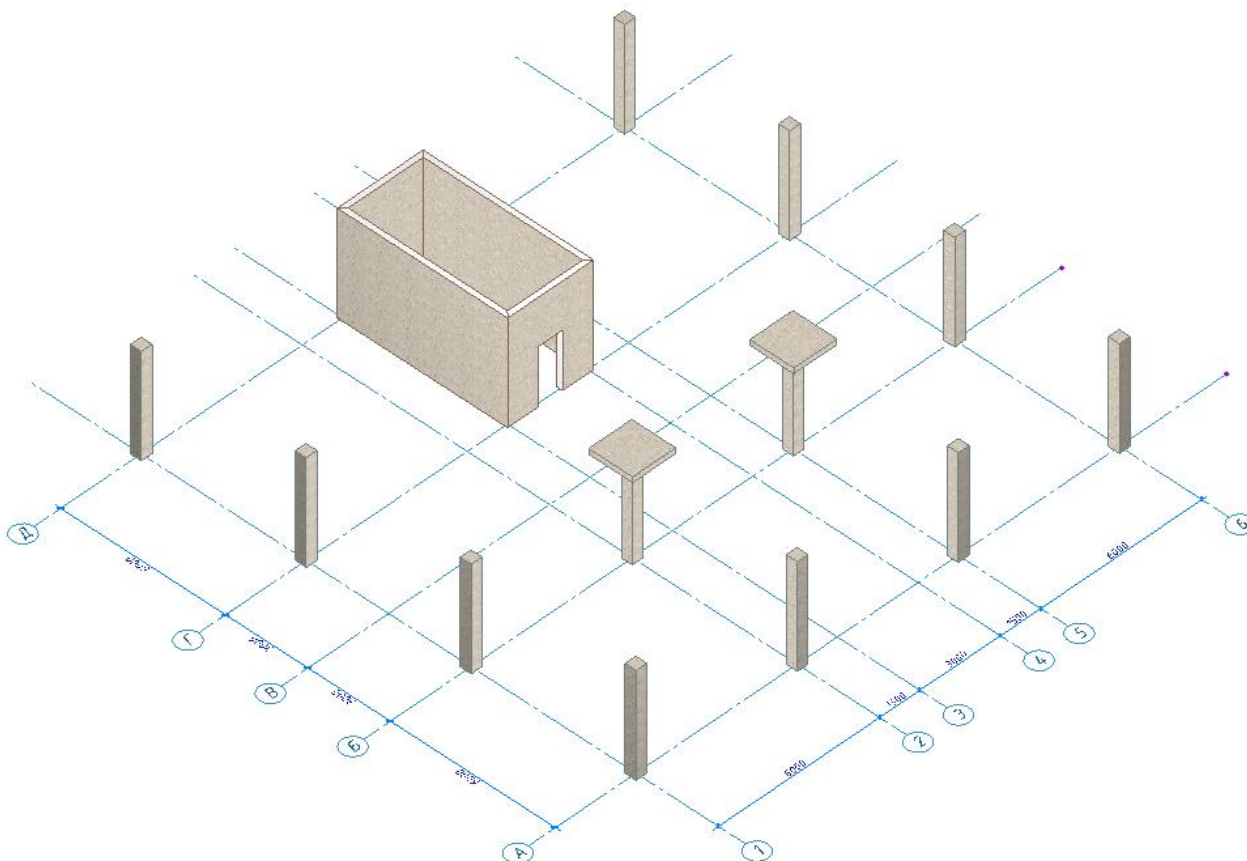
Схема расположения колонн для варианта безригельного каркаса
